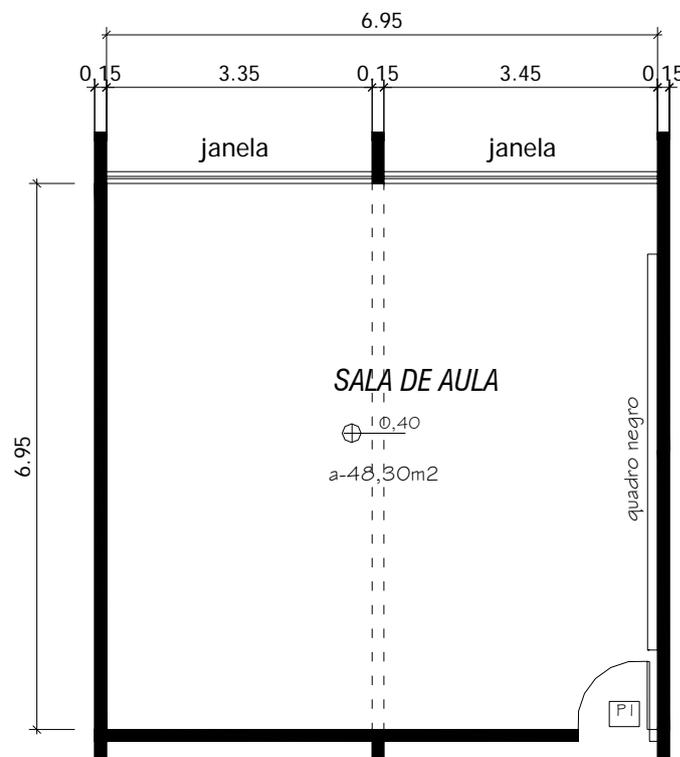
Sala de Aula Padrão - Planta Baixa .
